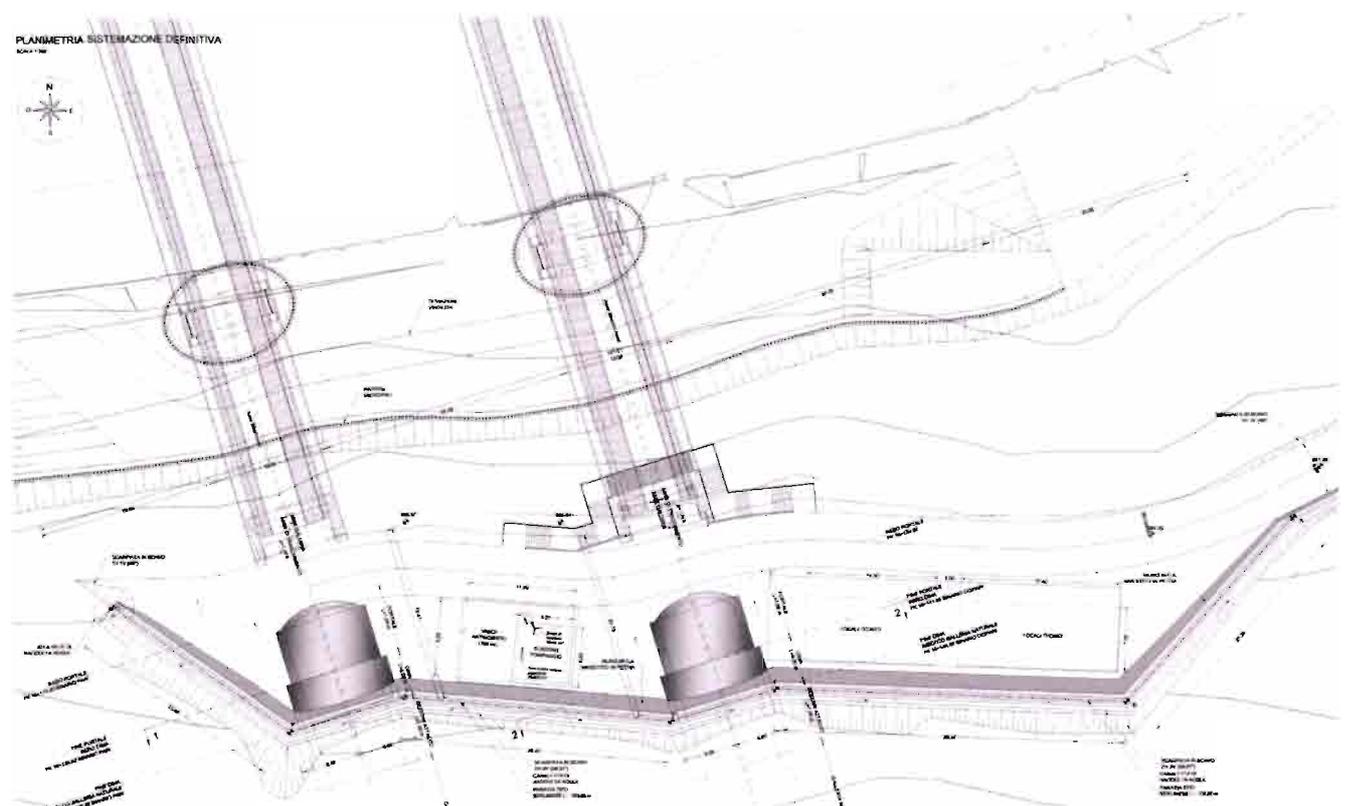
Gardena Nord - Stralcio planimetrico delle opere di imbocco.
